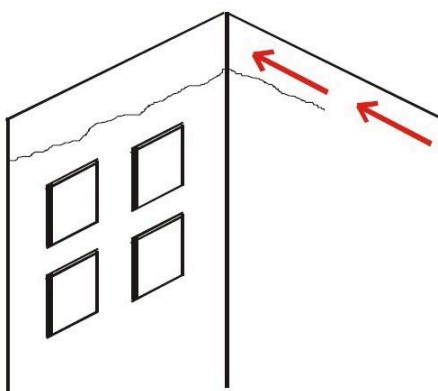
Fissura típica de movimentação térmica da laje (DUARTE, 1998).
